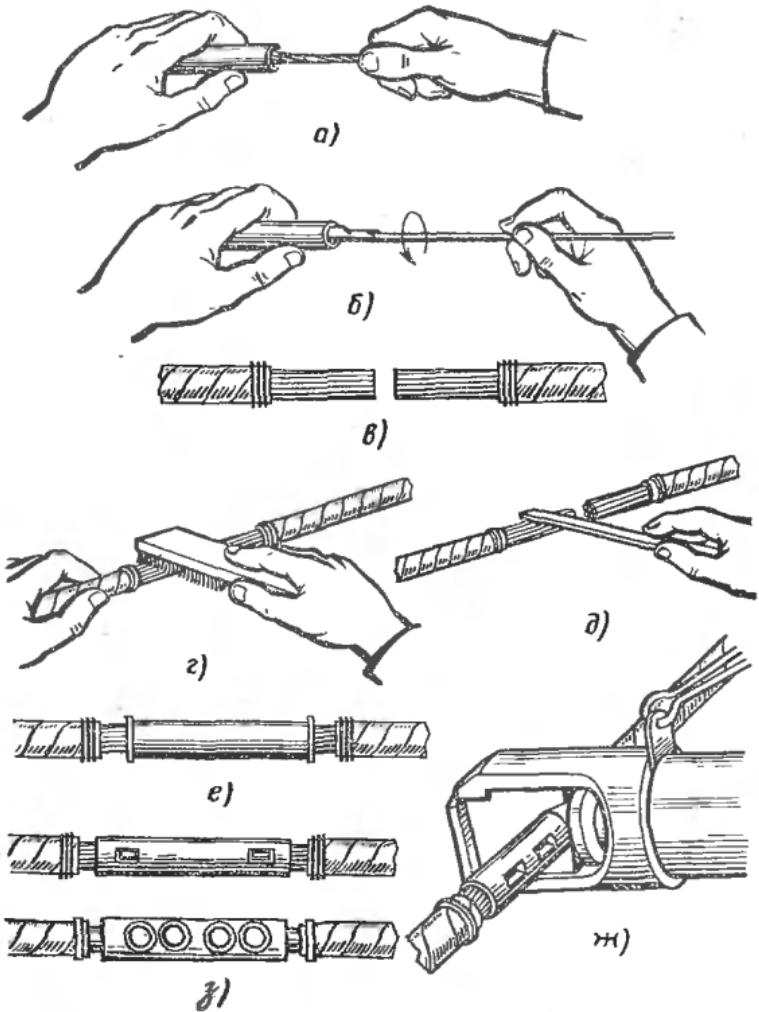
Соединение алюминиевых жил опрессовкой:
